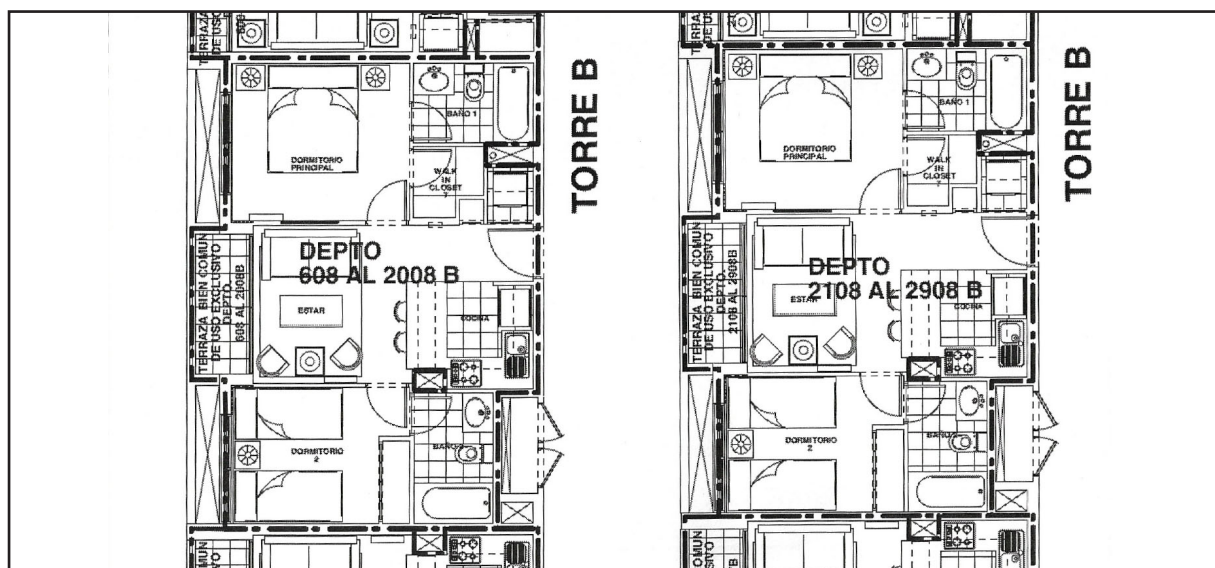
Plantas arquitectura departamentos 608 (izq.) y 2708 (der.). Fuente: DOM Estación Central
